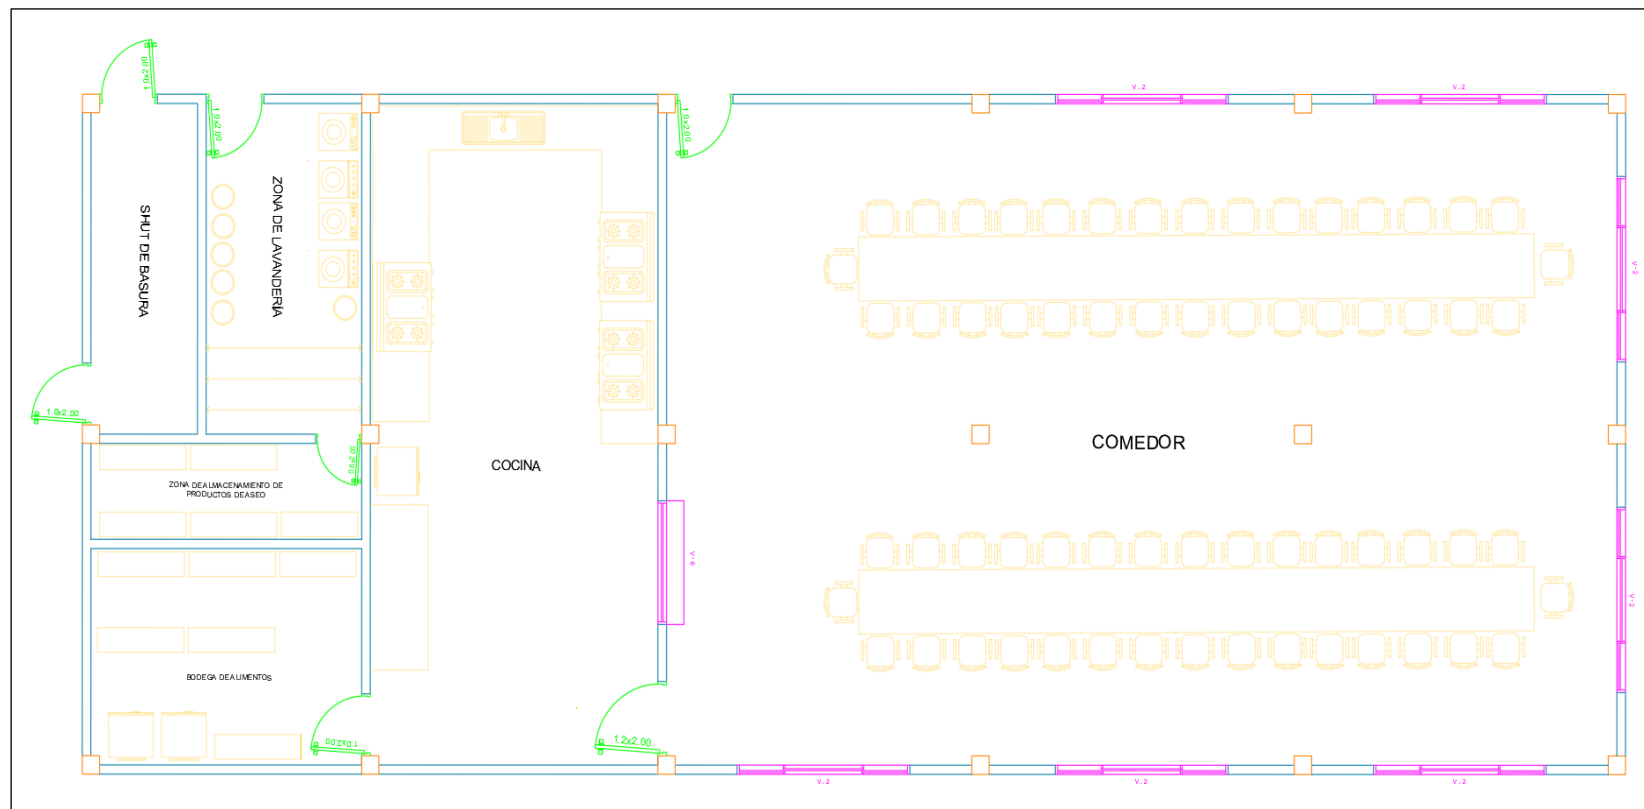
Diseño arquitectónico de la estructura 4 del Centro de Desarrollo Infantil.
